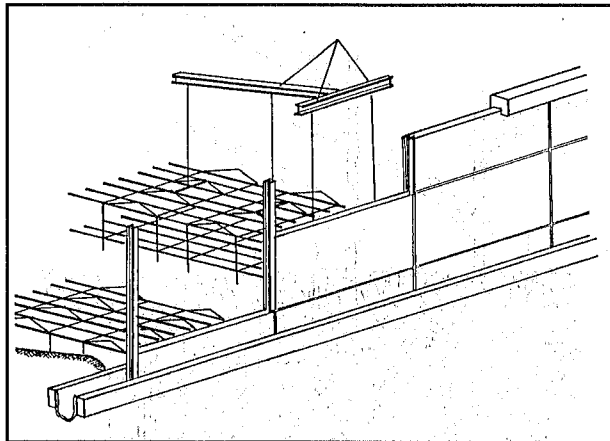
Bewehrte Erde - Schemazeichnung für Unterwasserkonstruktion [9]
